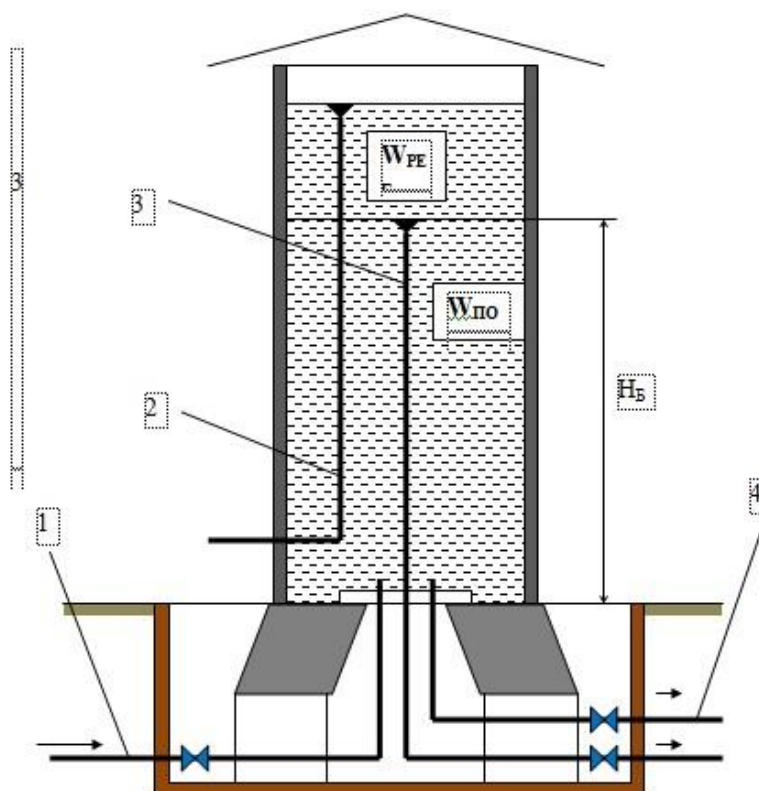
Схема оборудования гидроколонны: 1 – водопровод; 2 – переливная труба; 3 – хозяйственно-питьевой трубопровод; 4 – пожарный трубопровод.
